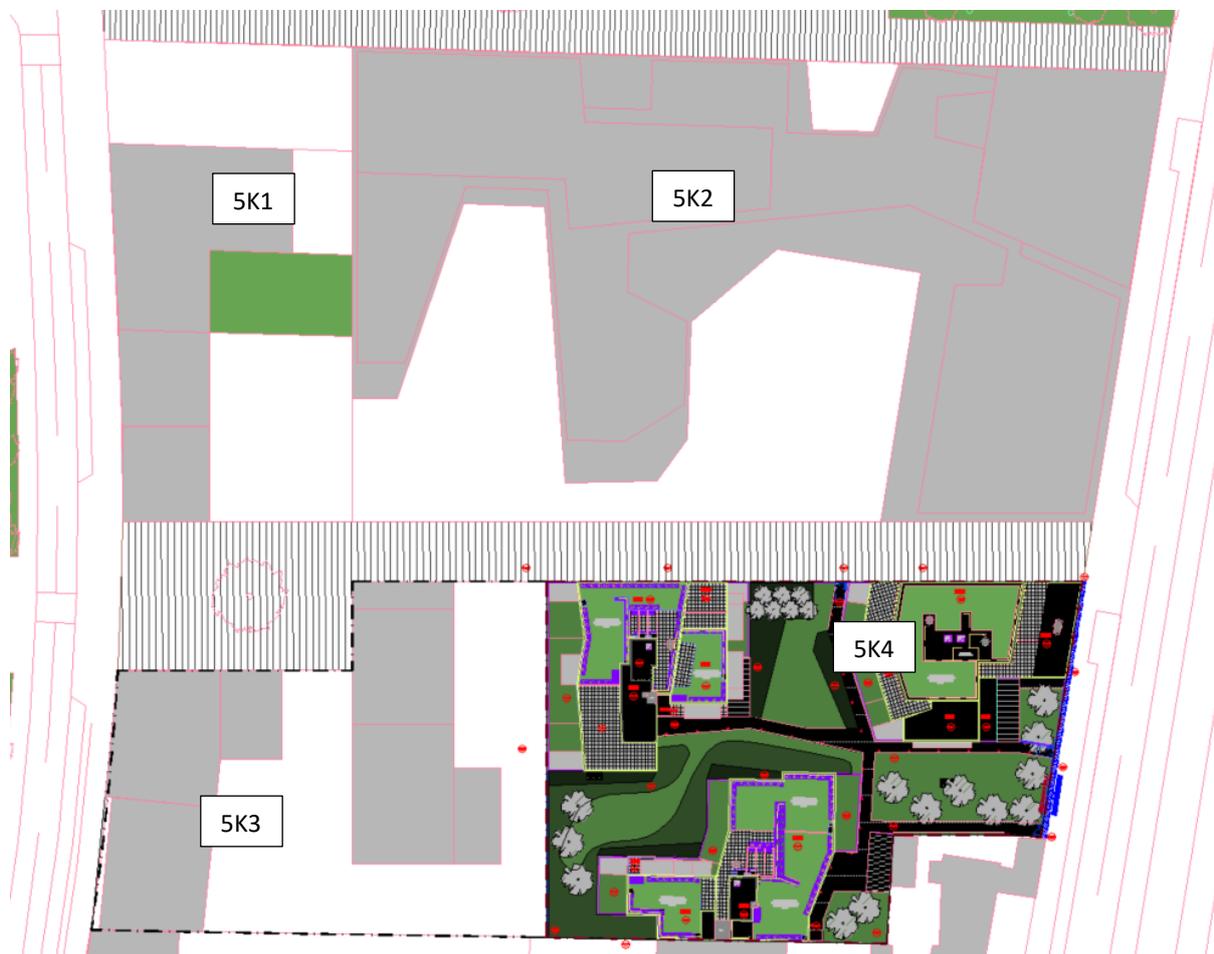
Plan masse du lot 5K4 et localisation des lots adjacents (Source : SADEV)
